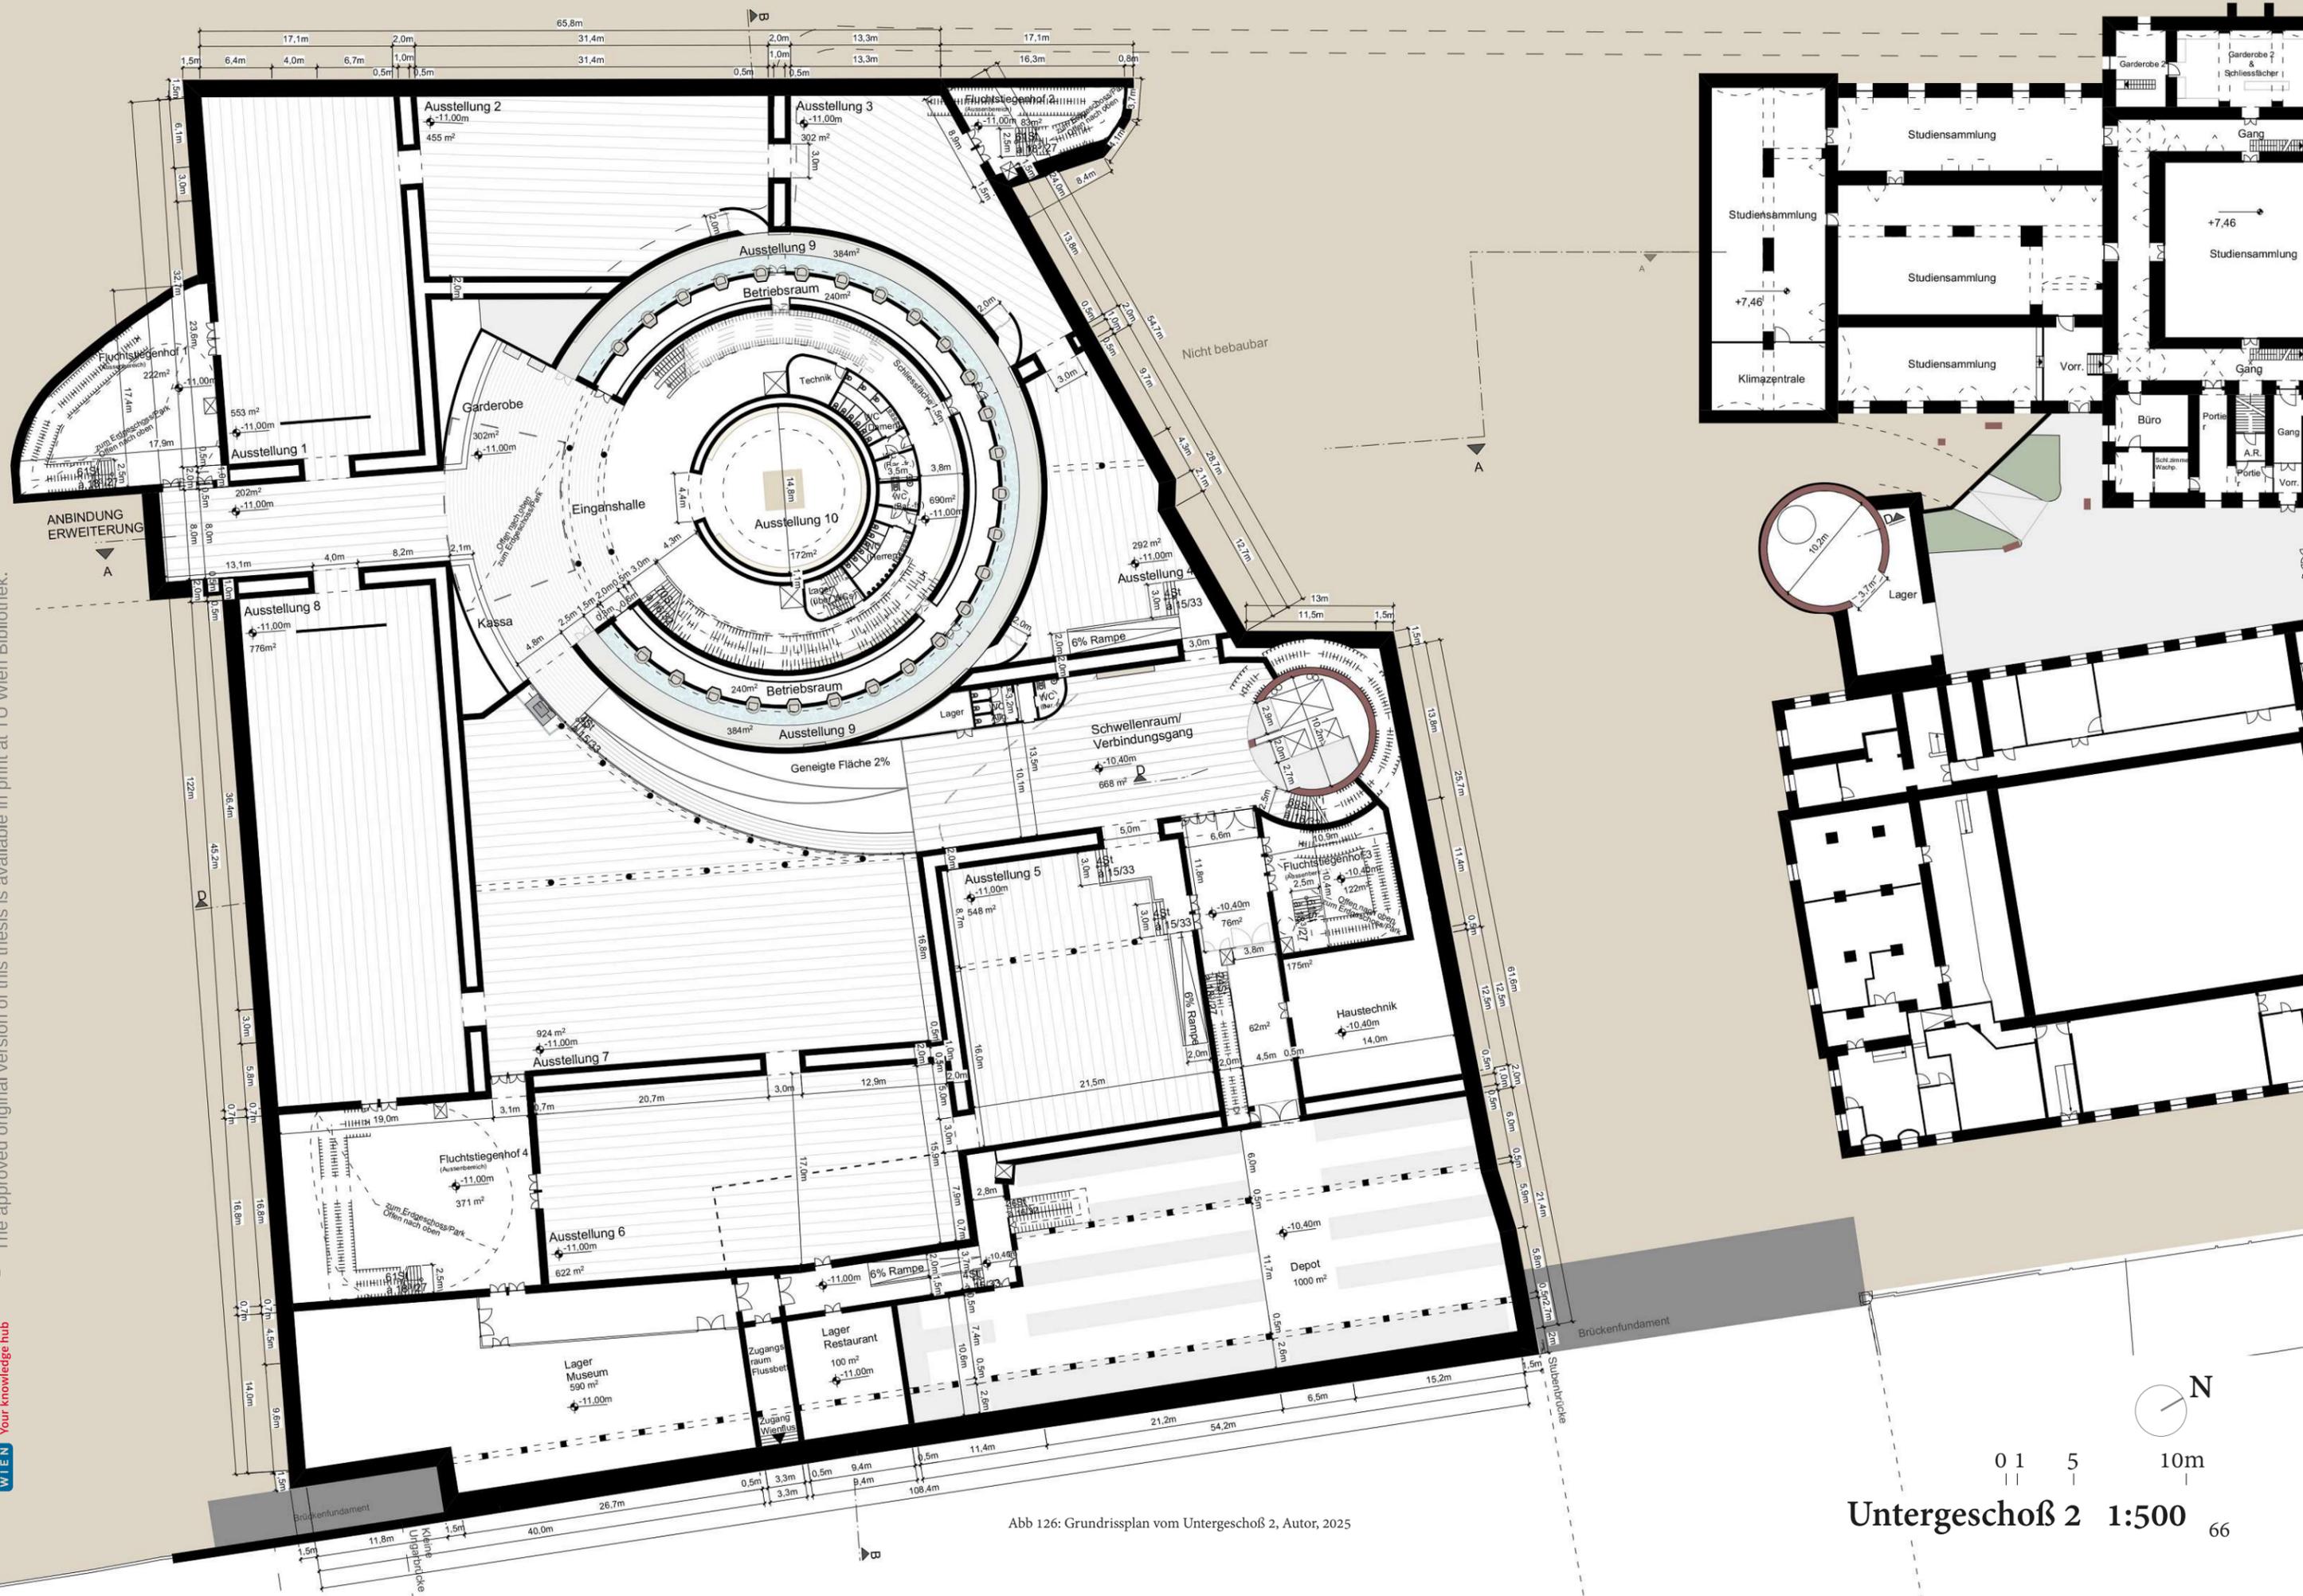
Grundrissplan vom Untergeschoß 2, Autor, 2025
